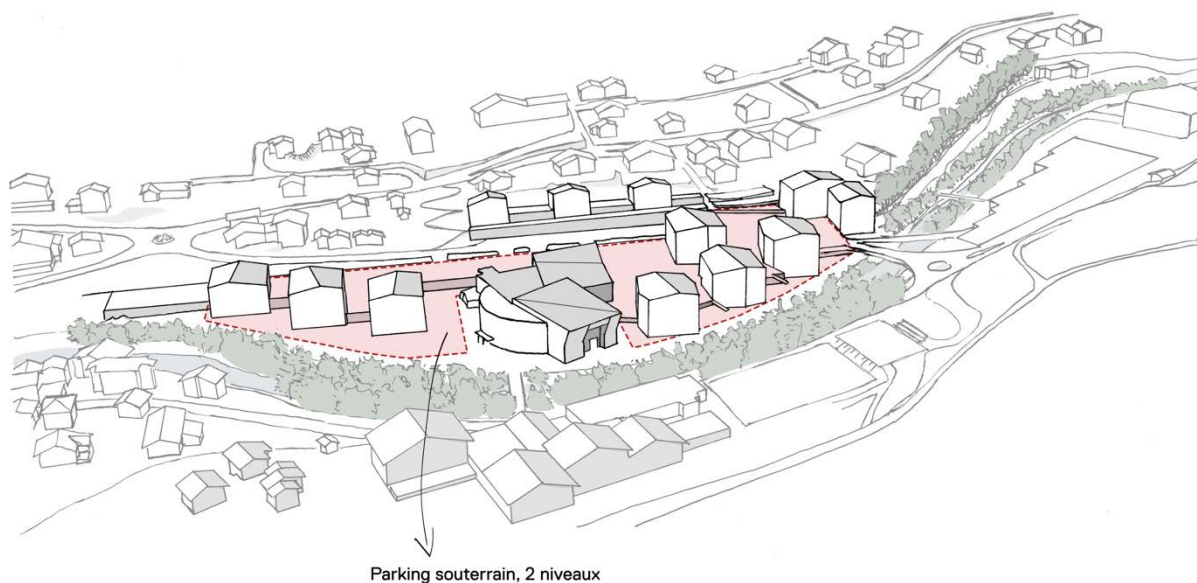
Emprise du futur parking souterrain, sur deux niveaux.
